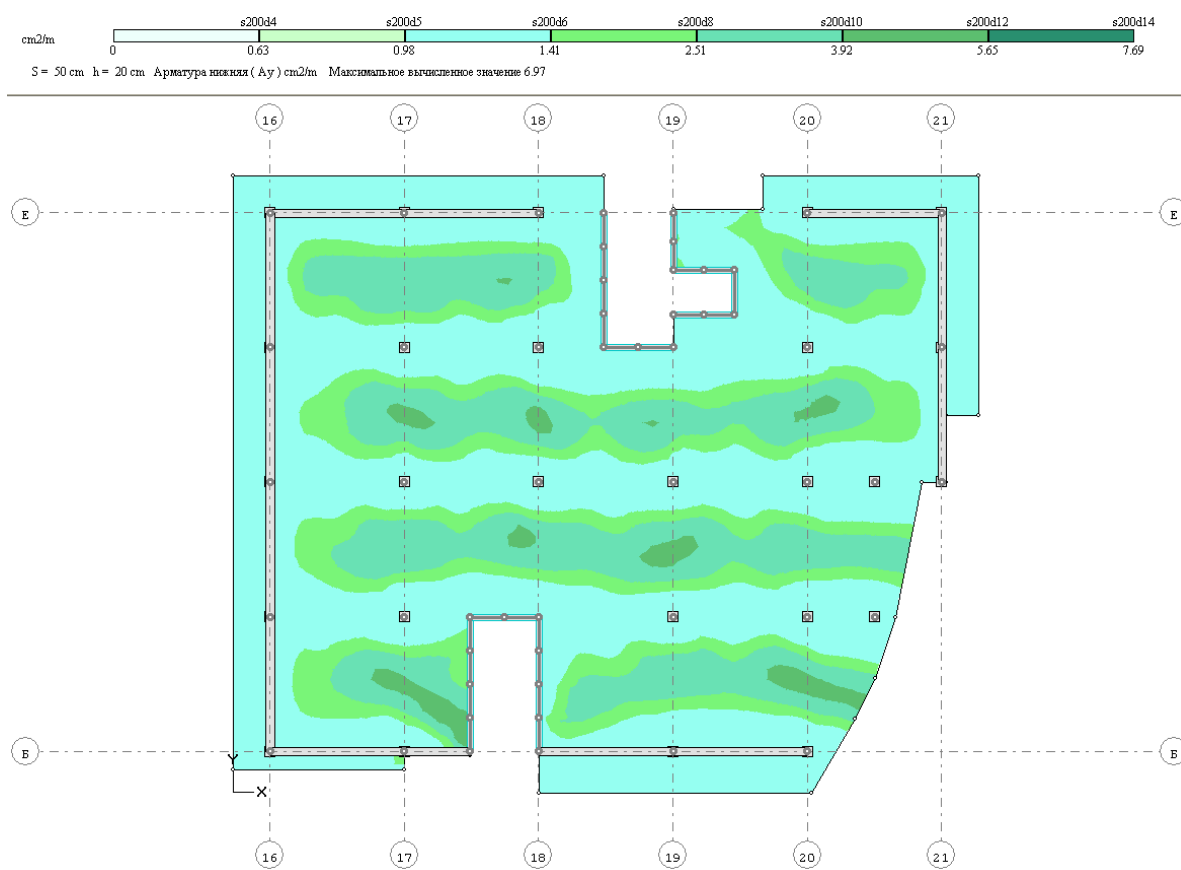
Схема нижнего армирования плиты перекрытия по оси OY
